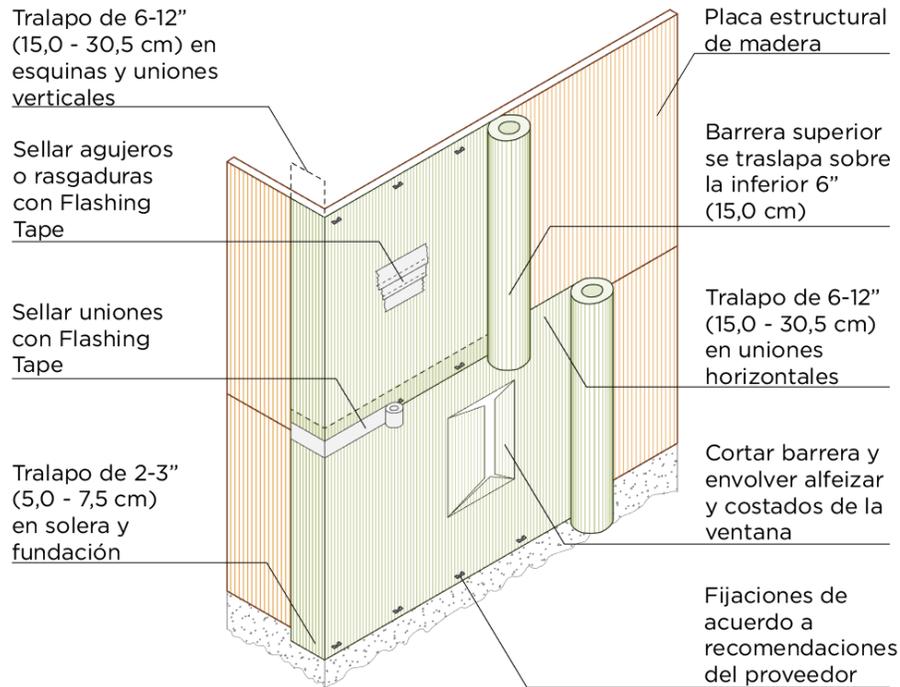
Detalles de instalación de barrera de humedad como plano de drenaje sobre muro. Redibujado.
